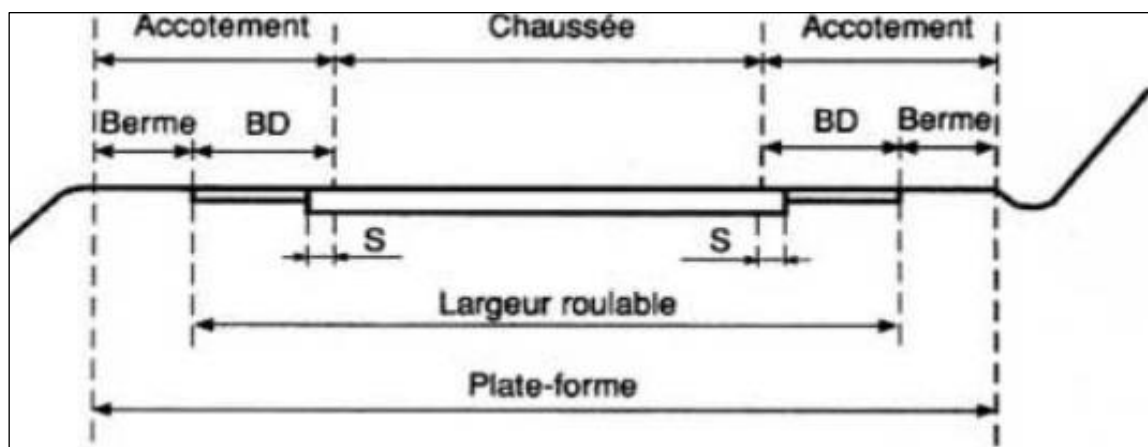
Profil en travers d'une route à 2 ou 3 voies.
